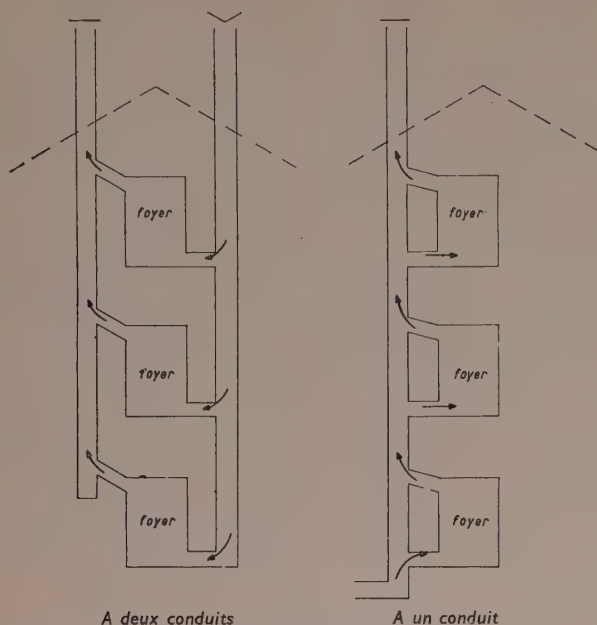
Dispositifs spéciaux de conduits d'air et de fumées pour appareils étanches.
